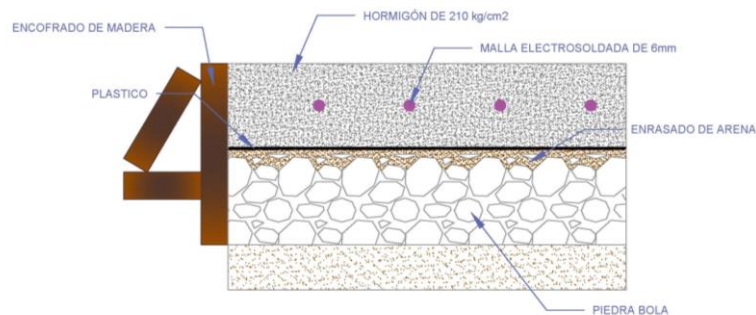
Detalle constructivo de la losa cimentación tipo contra piso plancha
